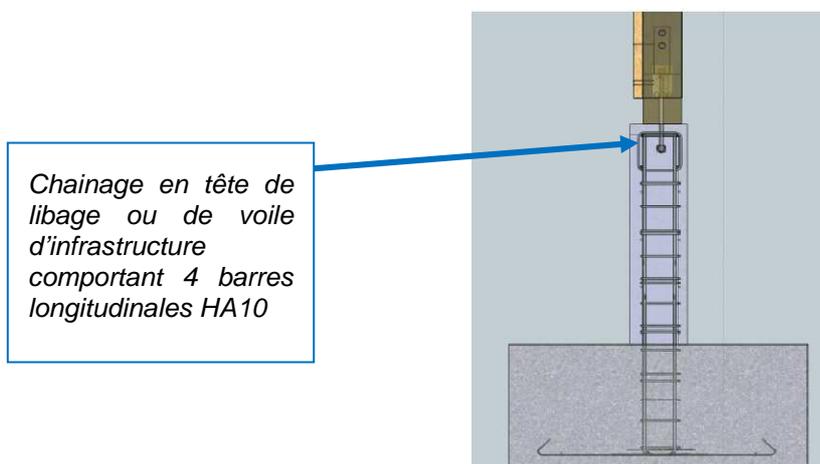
Coupe transversale schématique au droit de l'ancrage des panneaux de contreventement.
